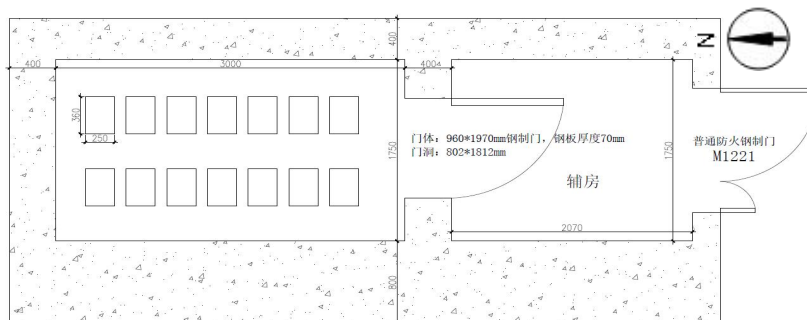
现有放射源库扩容改造前平面布局图（单位：mm）
